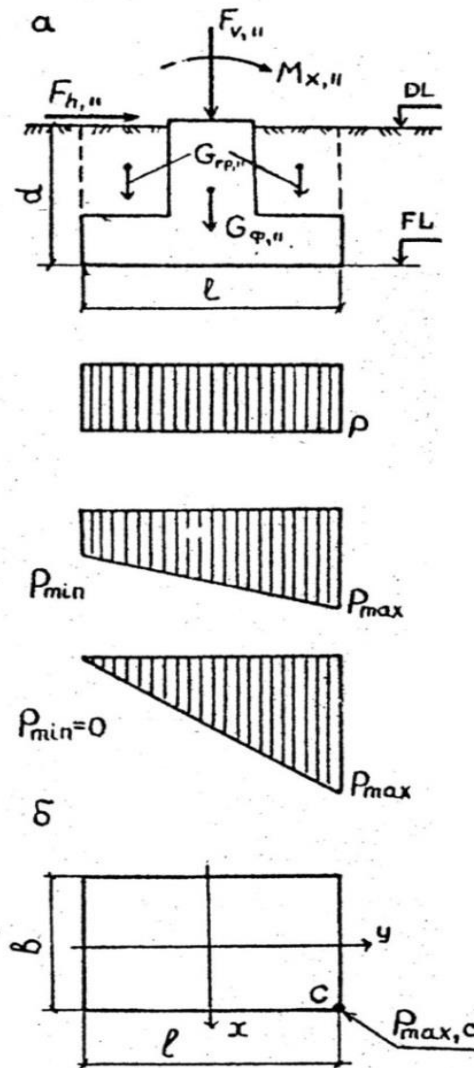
Схема действия сил, возможные эпюры контактных давлений (а) и план подошвы фундамента (б).
